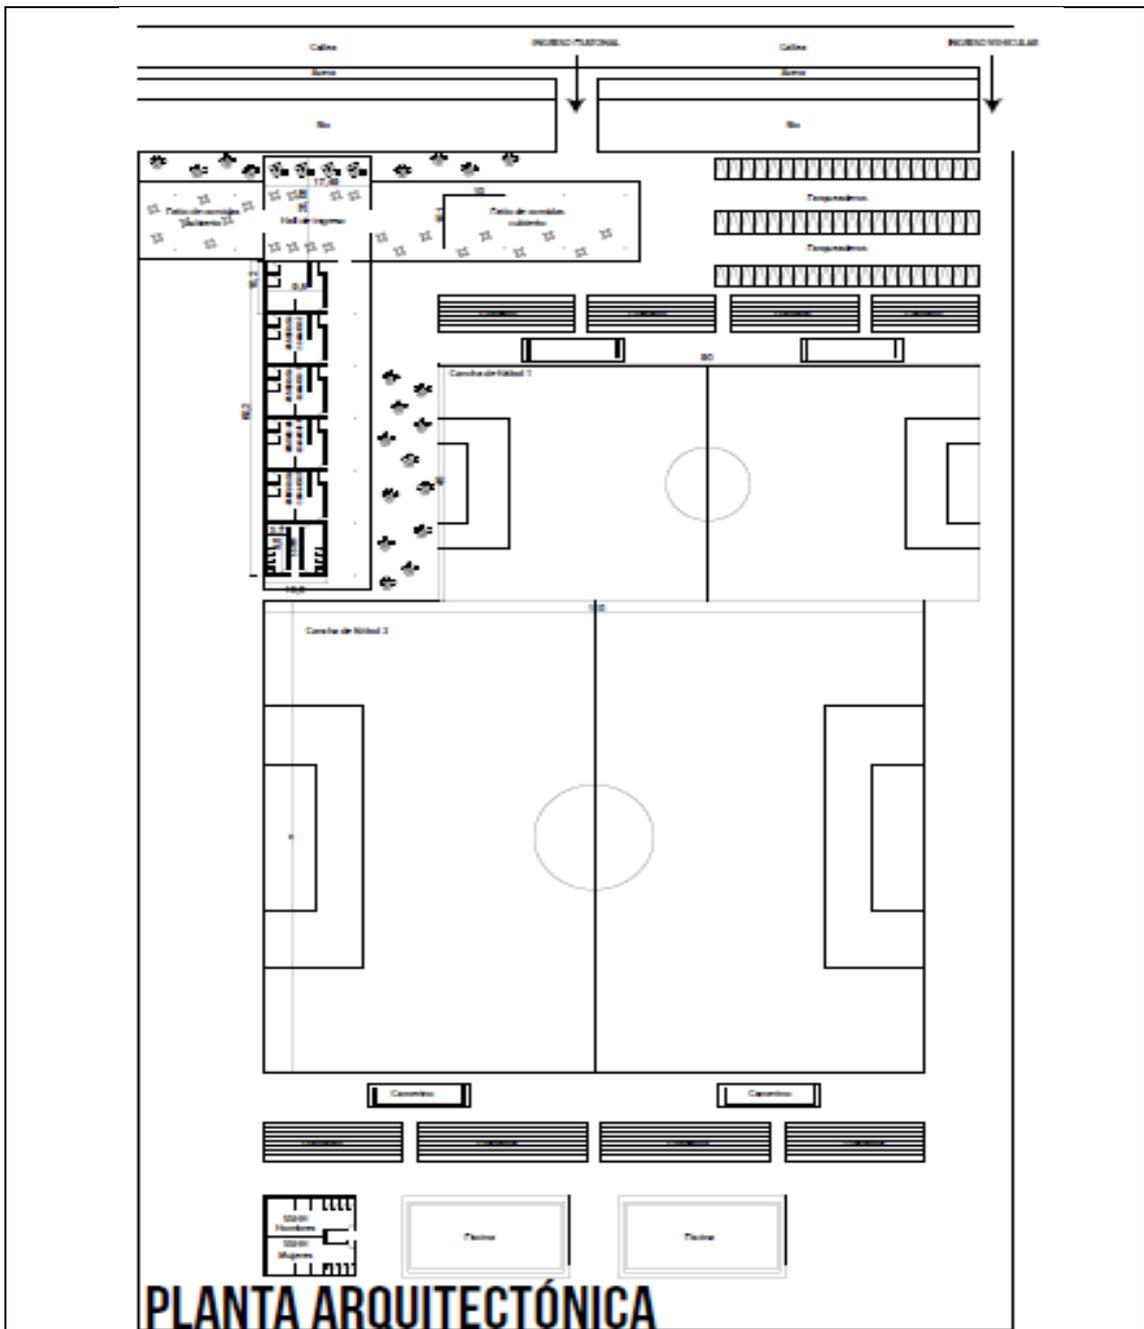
Planta Arquitectónica Complejo Turístico de la Comuna Chongón.
